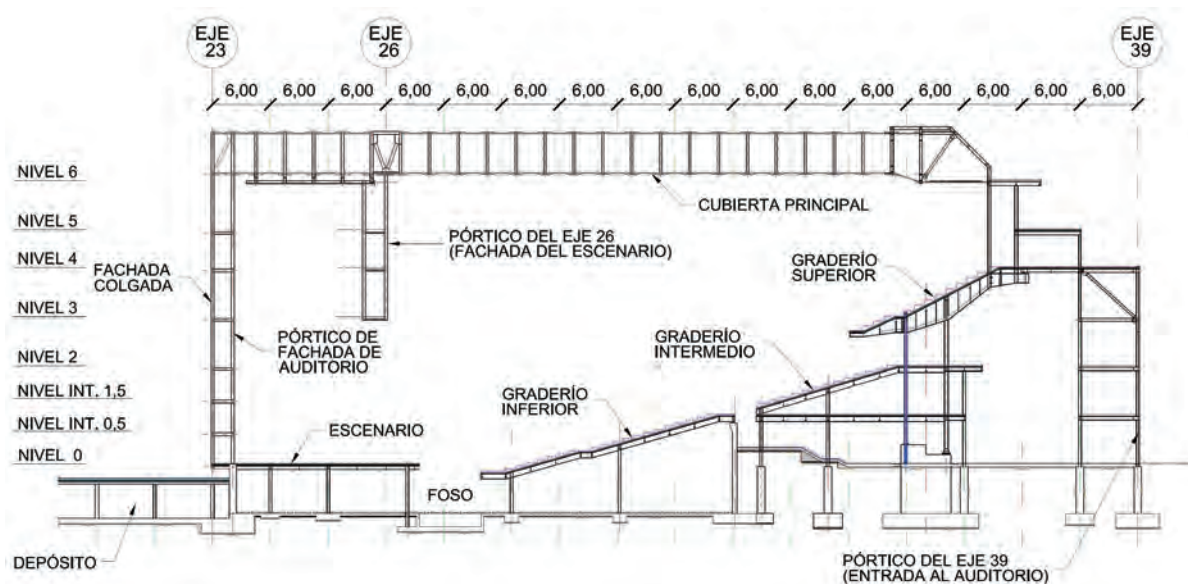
Corte por el eje del auditorio y vista de la cubierta
